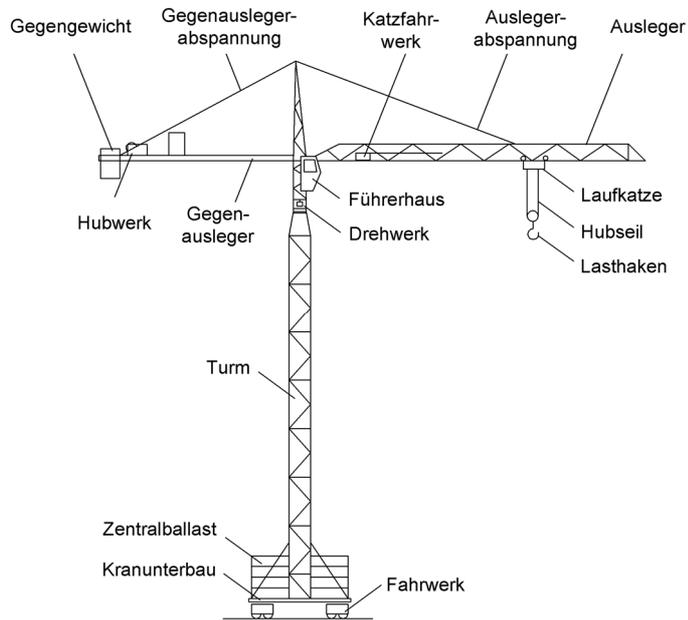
Bauelemente eines Obendrehers mit horizontalem Ausleger¹⁵
